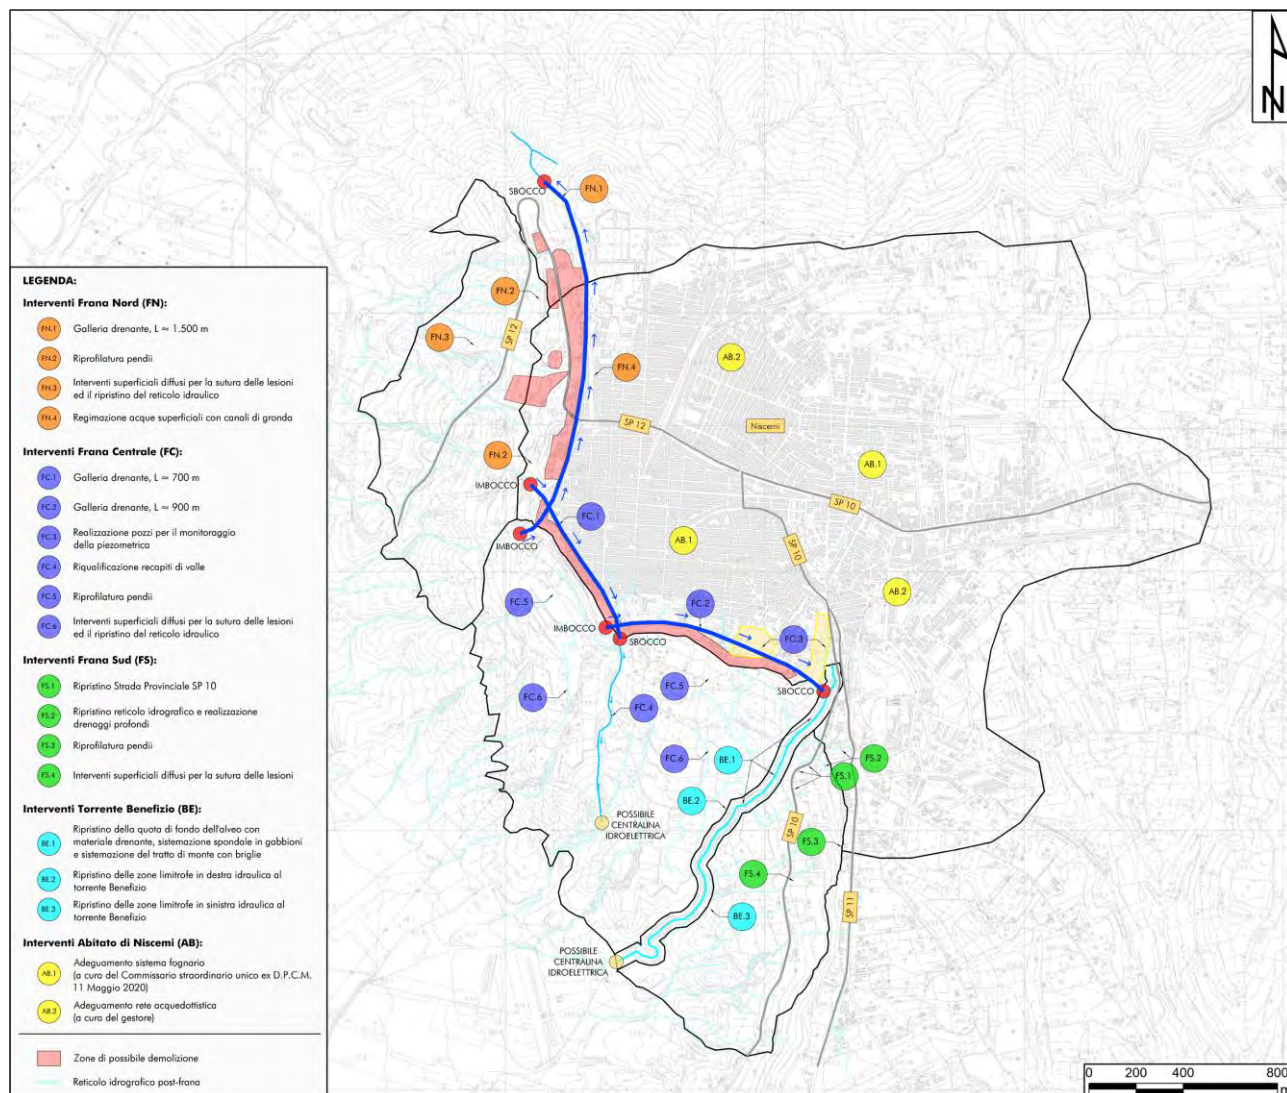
Planimetria con ubicazione degli interventi previsti dal programma.
